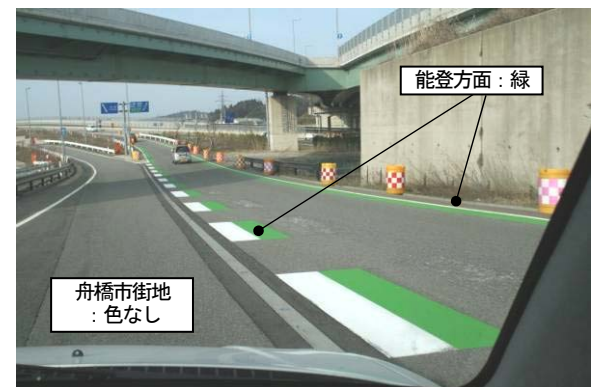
施工状況（能登方面-舟橋市街地分岐部）
